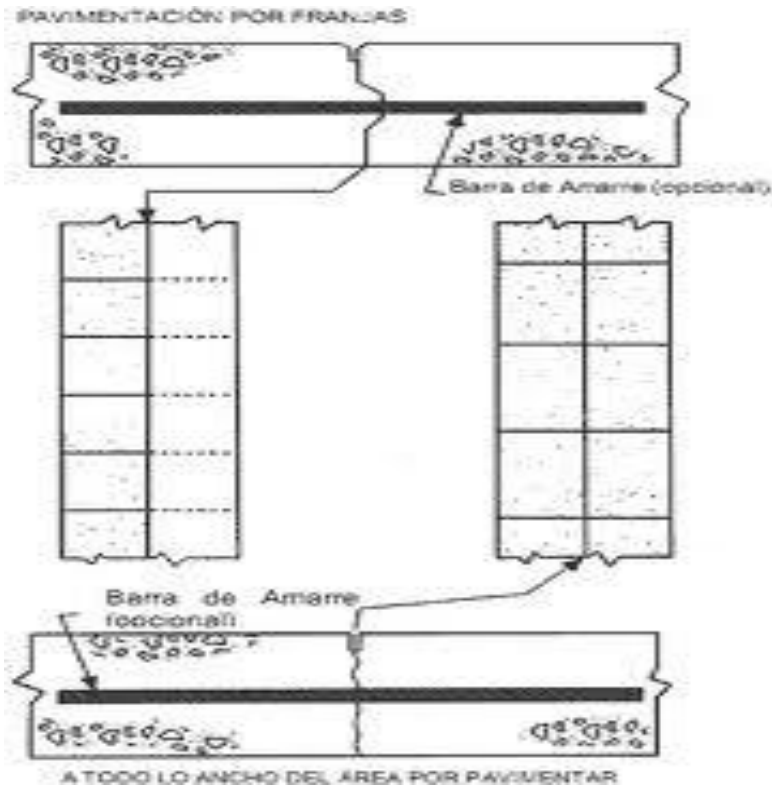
b.19 Juntas longitudinales de contracción y construcción.
